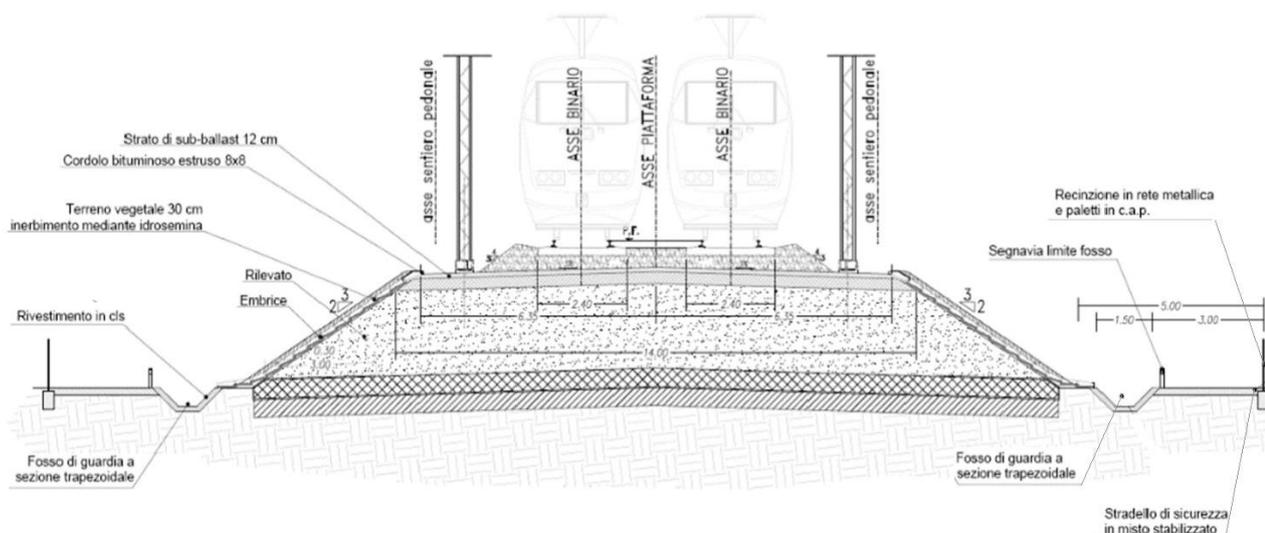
Sezione ferroviaria in rilevato a doppia linea
